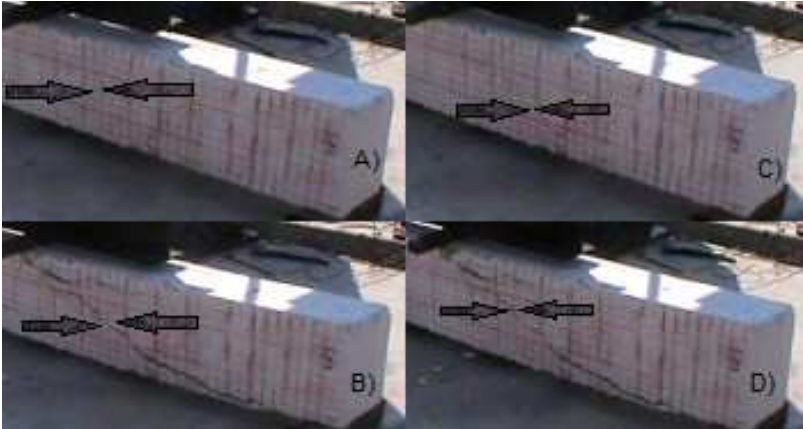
Patrón de grietas de la viga CR3.
